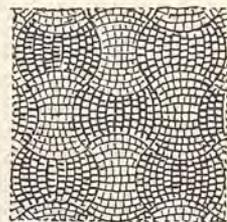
Mosaico in un pavimento, a Parenzo.
